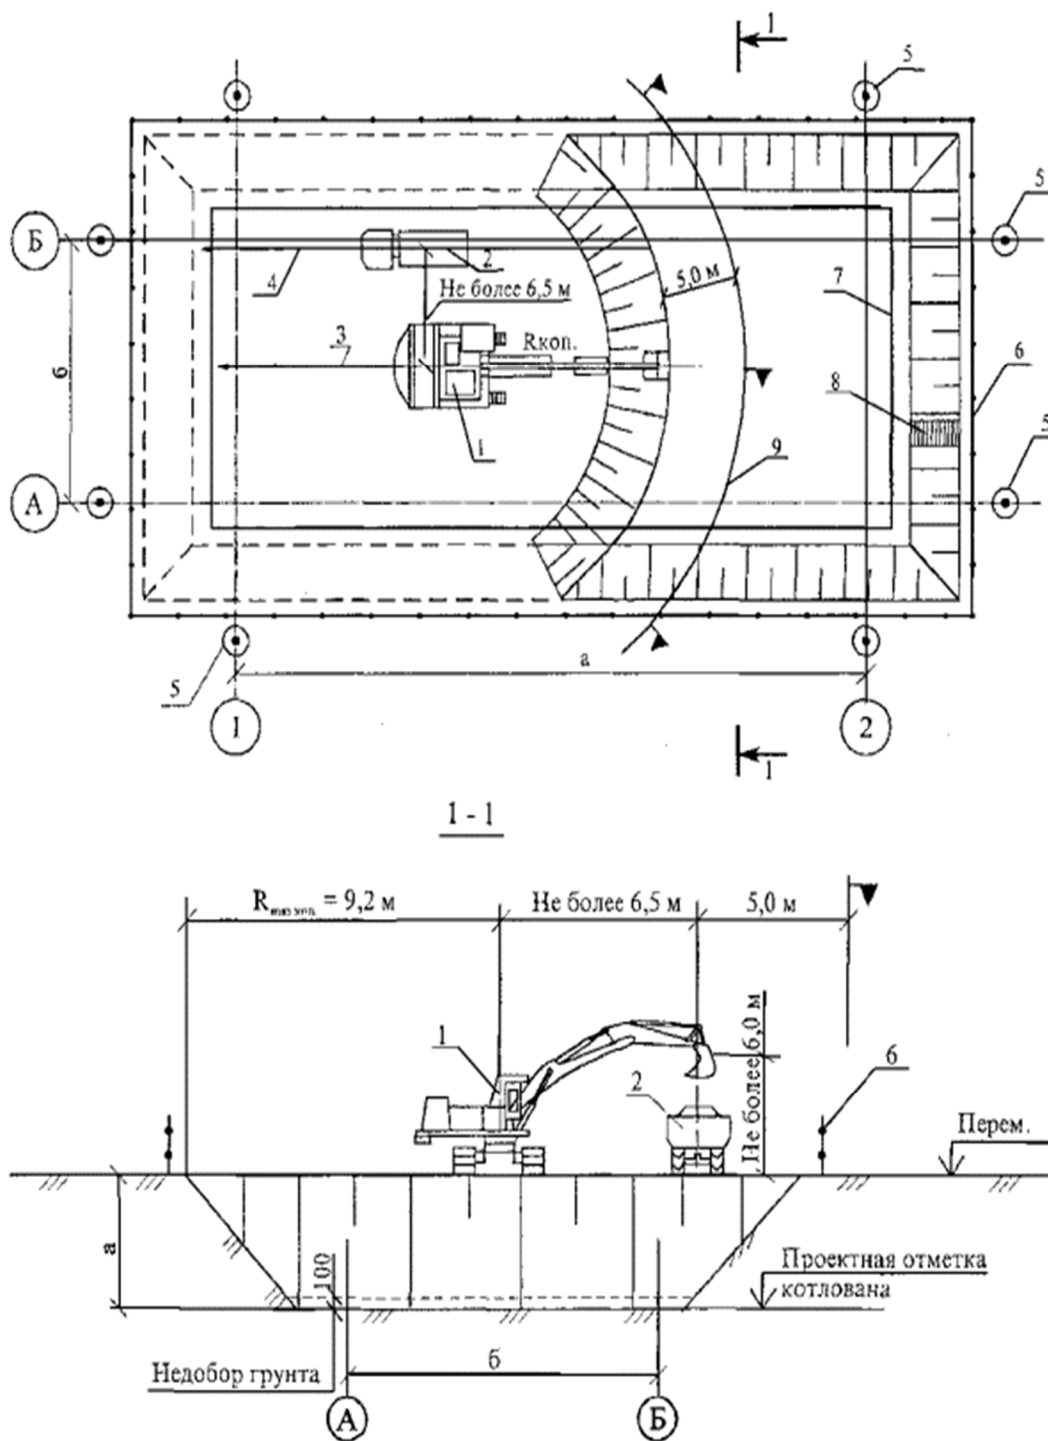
Схема разработки грунта котлована при лобовой проходке
